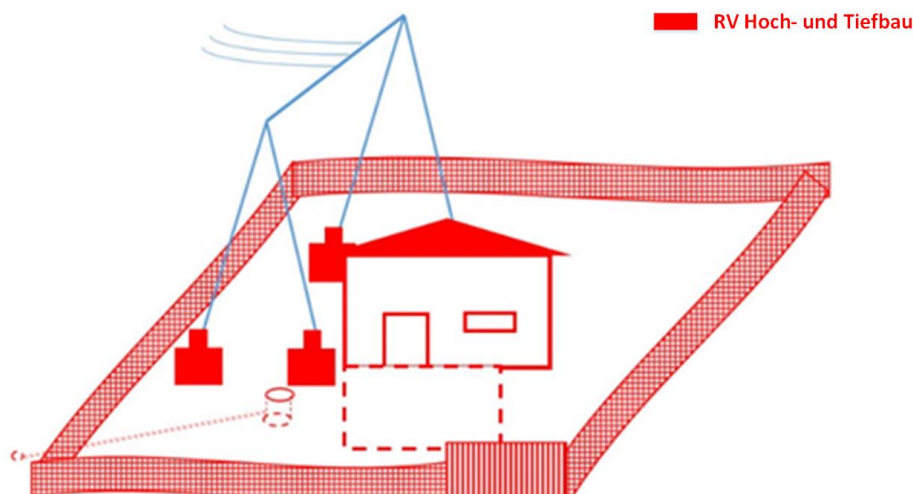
Schnittstelle Rahmenvertrag (RV) Hoch- / Tiefbau Planer (rot) zu Primärtechnik / SAS (Anlagen innerhalb vom Zaun)
